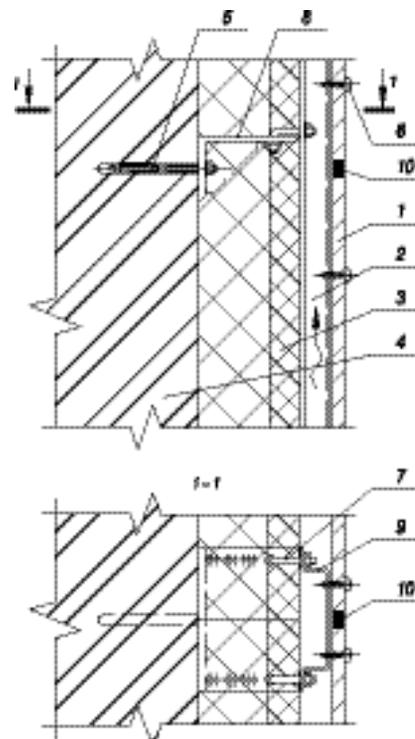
Конструкция вентиляруемой системы утепления «Радекс»: 1 – облицовка; 2 – вентиляруемый зазор; 3 – теплоизоляционный слой; 4 – стена здания; 5 – анкерные устройства; 6 – самонарезающий винт; 7 – шпилька крепежная; 8 – опорный столб; 9 – профиль металлический; 10 – силиконовая мастика
